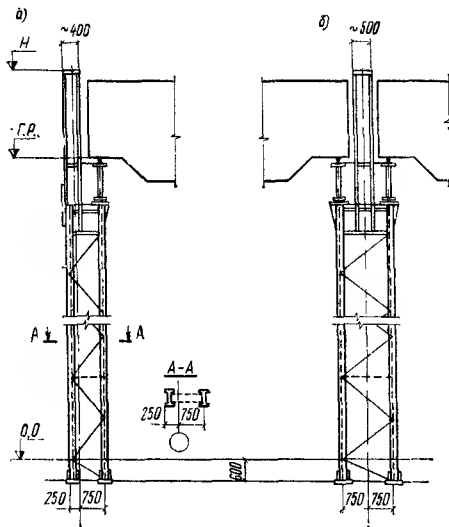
Колонны ступенчатого типа для крановых зданий без проходов вдоль подкрановых путей
